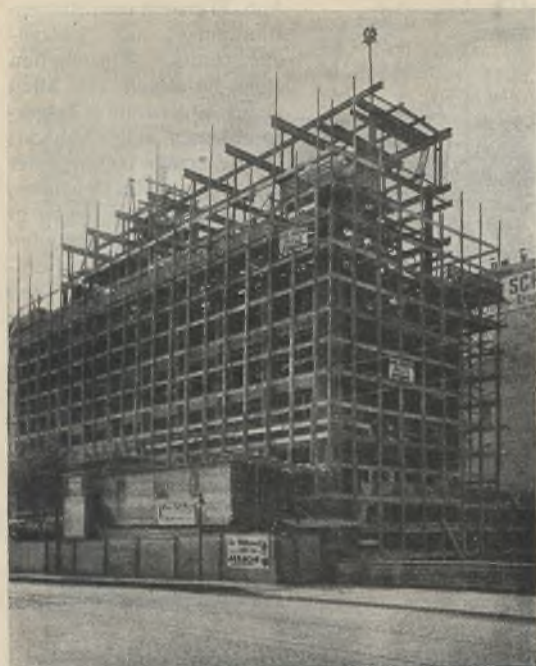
Neubau der Firma Erich Schüler am Heidkampsweg. (Ausführung der Stahlkonstruktion: Carl Spaeter G. m. b. H., Hamburg.)
